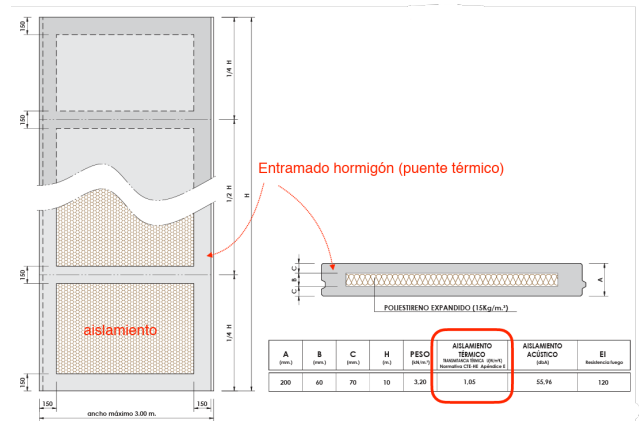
Panel Prefabricado de Hormigón - Sandwich con aislamiento y puente térmico
